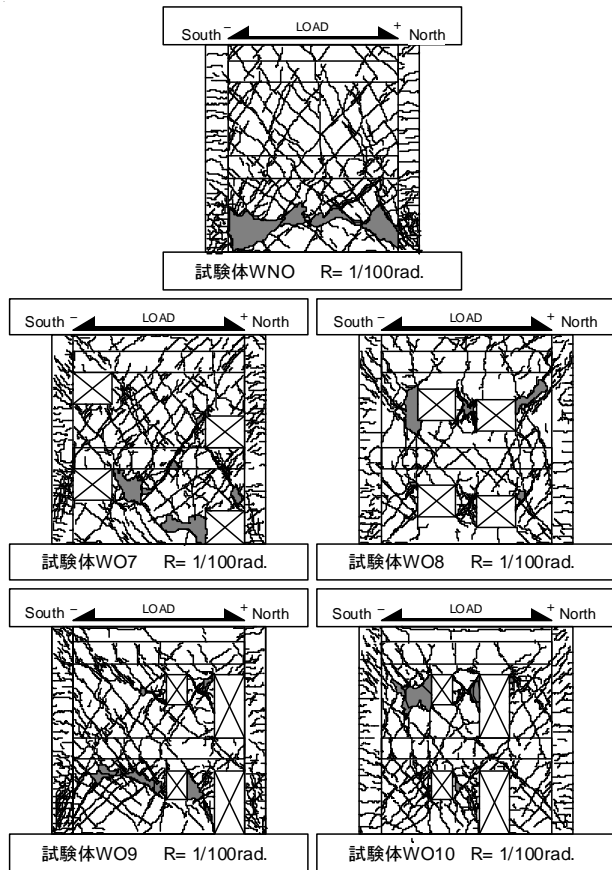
ひび割れ破壊状況 (R=1/100rad. サイクル終了時)
